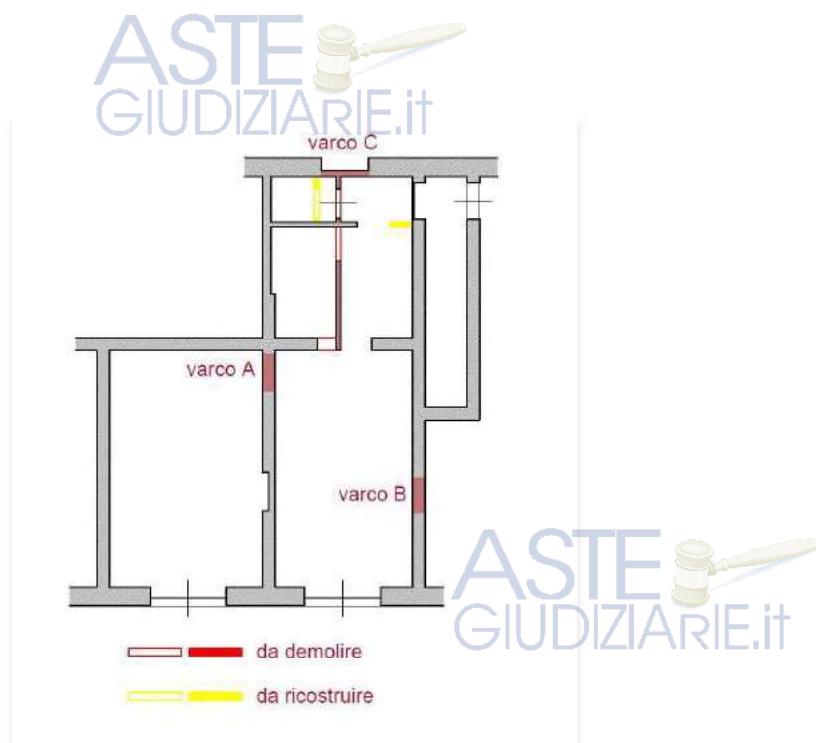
stato di fatto con evidenza delle difformità rilevate.
